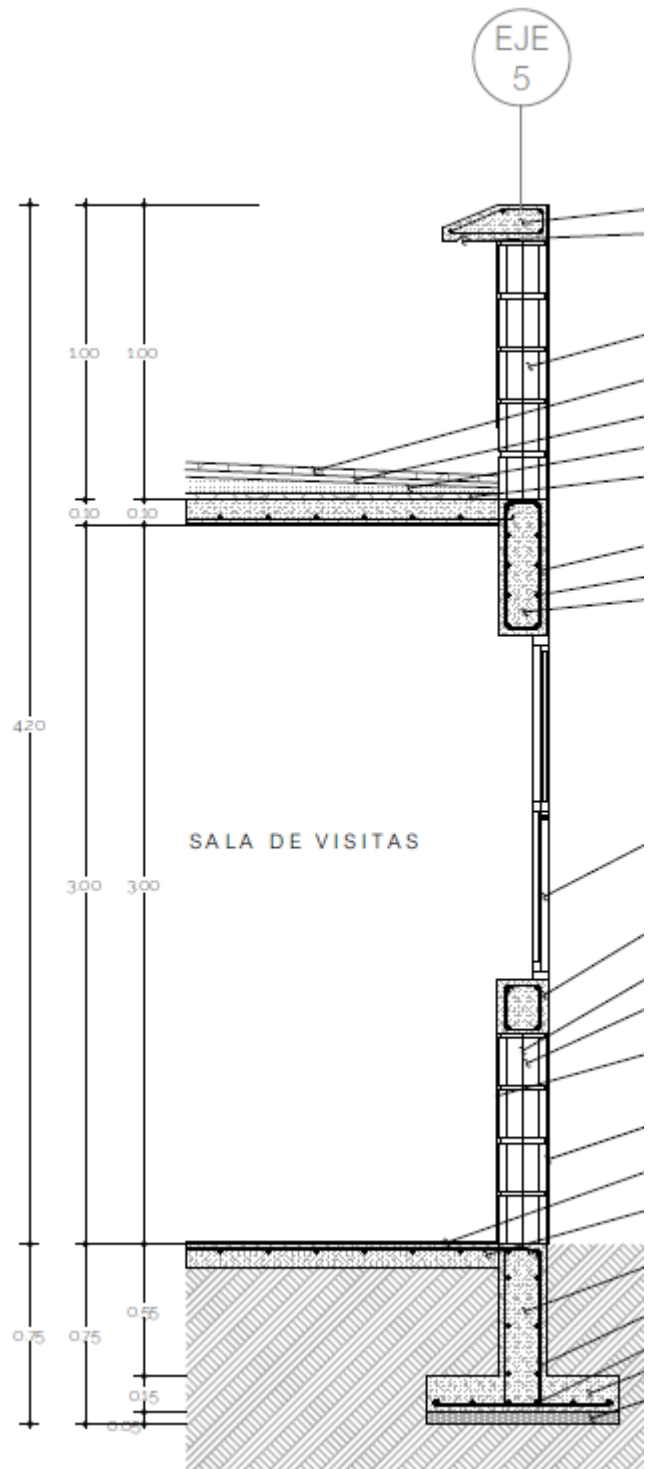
Imagen ilustrativa, revisar especificaciones en el plano E-05
